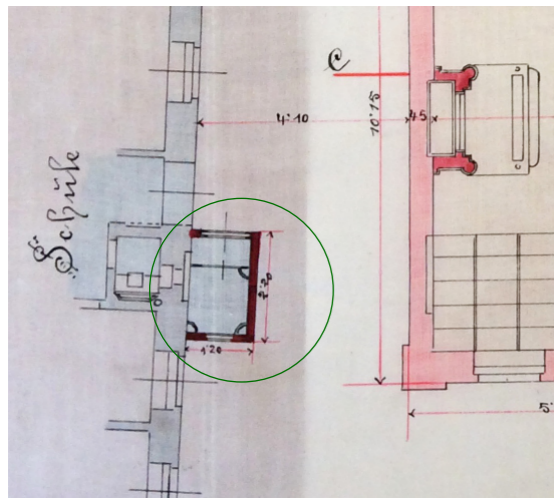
Grundriss Einreichung (1884) [ma37]
